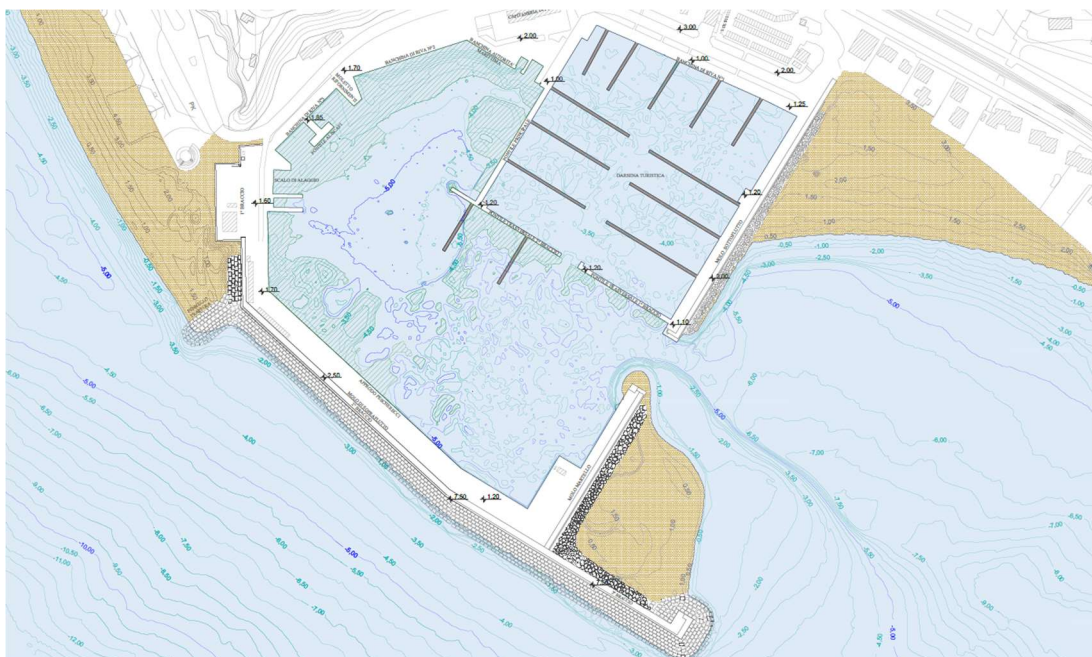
Planimetria rimodellamento fondali interni (aree da livellare in verde)
